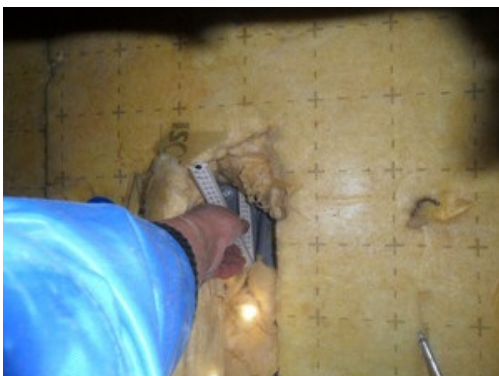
Onjuist aangebrachte ankerrail t.b.v. geveldragers blok 15 (foto Toezicht Bouw Stadsdeel Oost 31-08-15)
